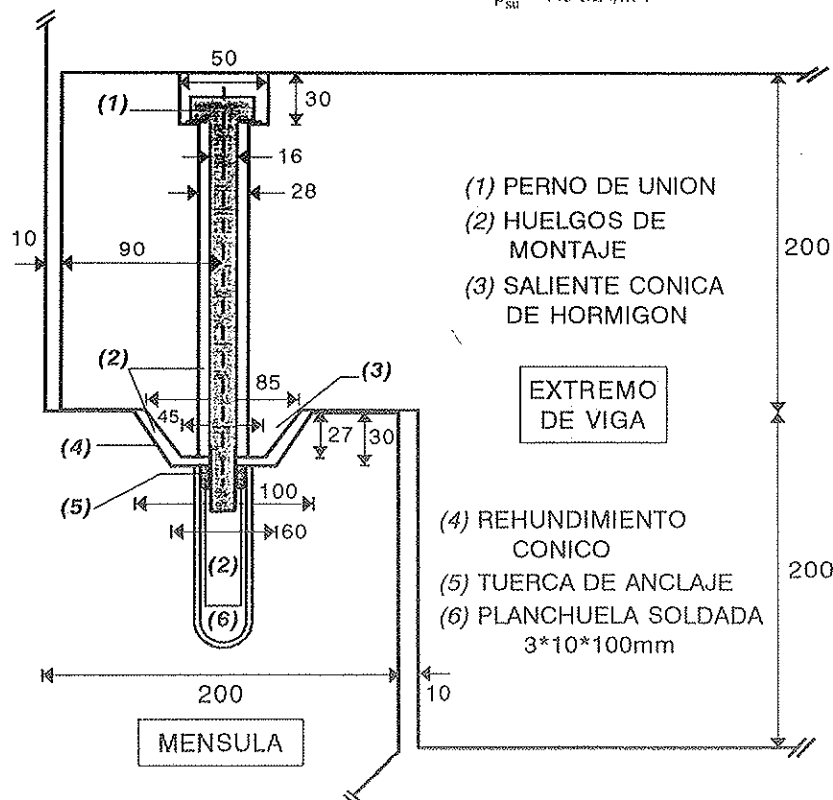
Detalle constructivo de la unión por encastre seca (ES).
